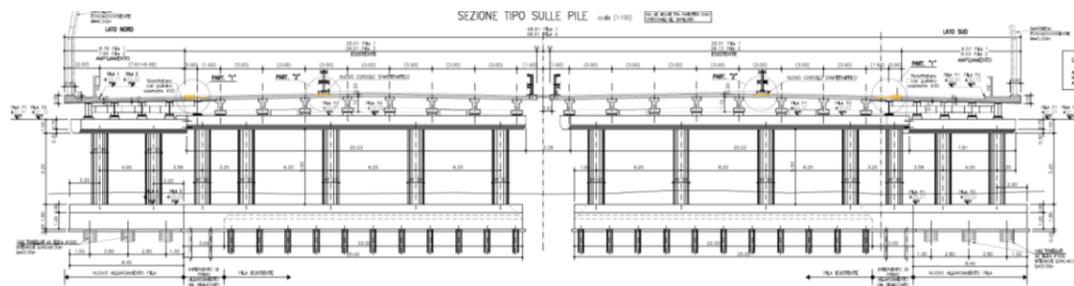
Sezione tipo di progetto ponte sul canale Navile²³
